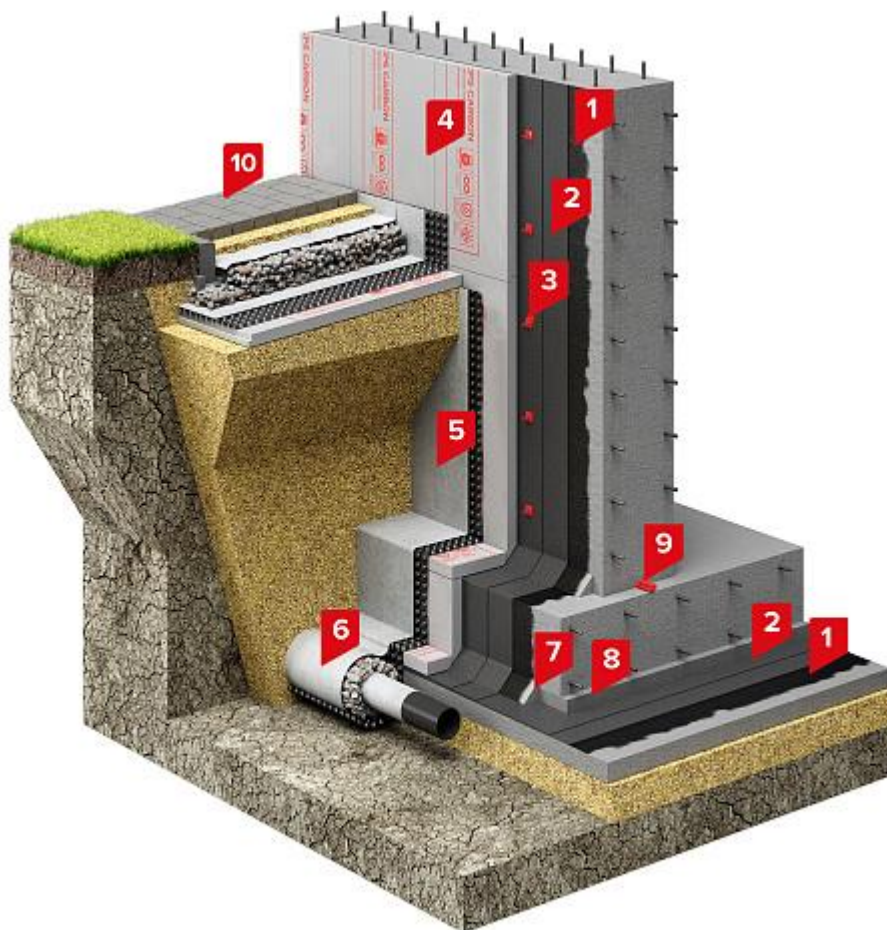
SD-ФУНДАМЕНТ Дренаж Термо [23]
